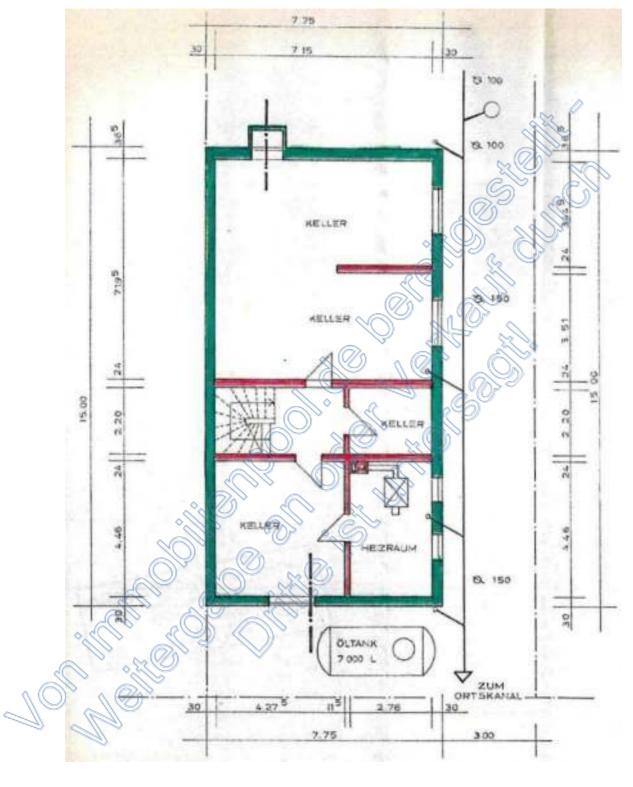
Grundrissplan Kellergeschoss (aus Bauakte 1973)
